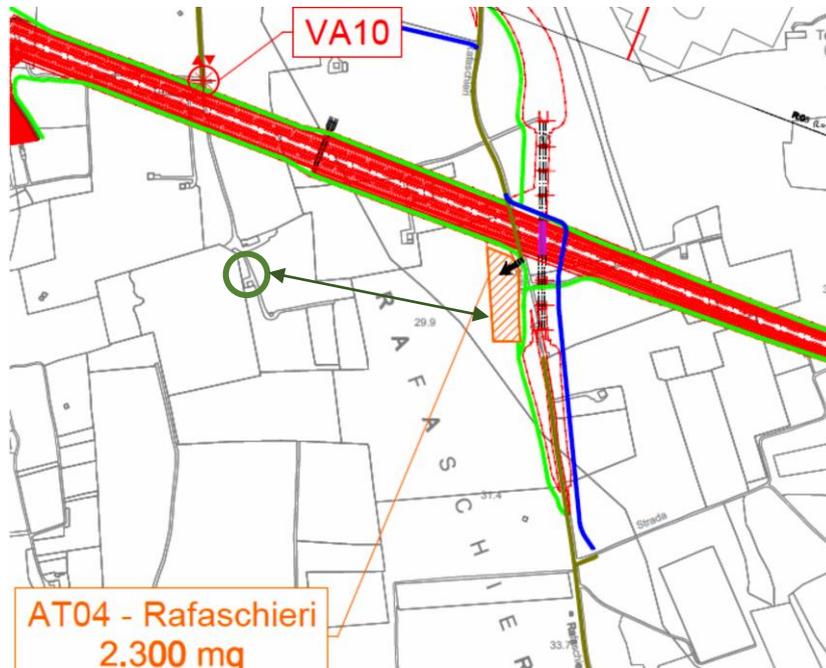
Area di cantierizzazione presso AT04 Rafaschieri – il ricettore più prossimo A-R-234 si trova a 260m a Ovest
